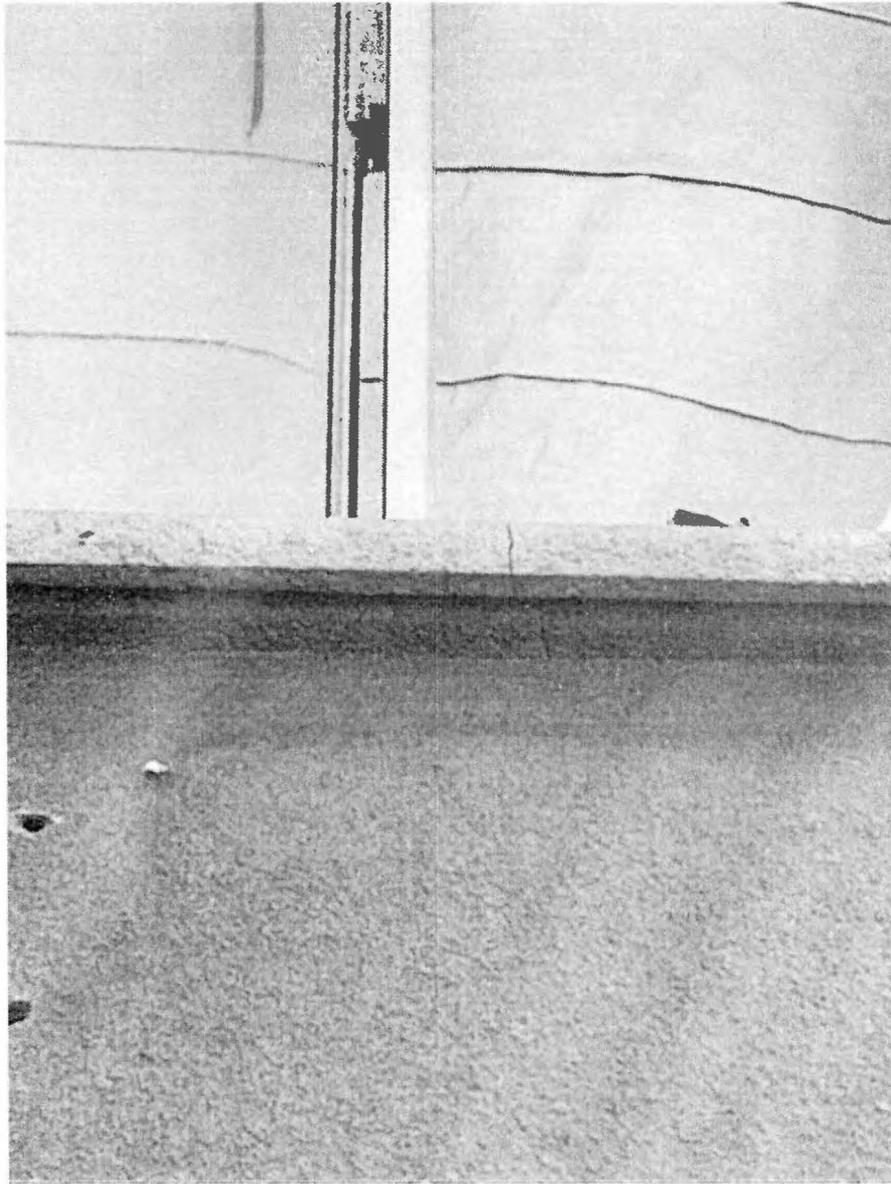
Fisuramiento típico en marquesinas de ventanas de fachada este.
